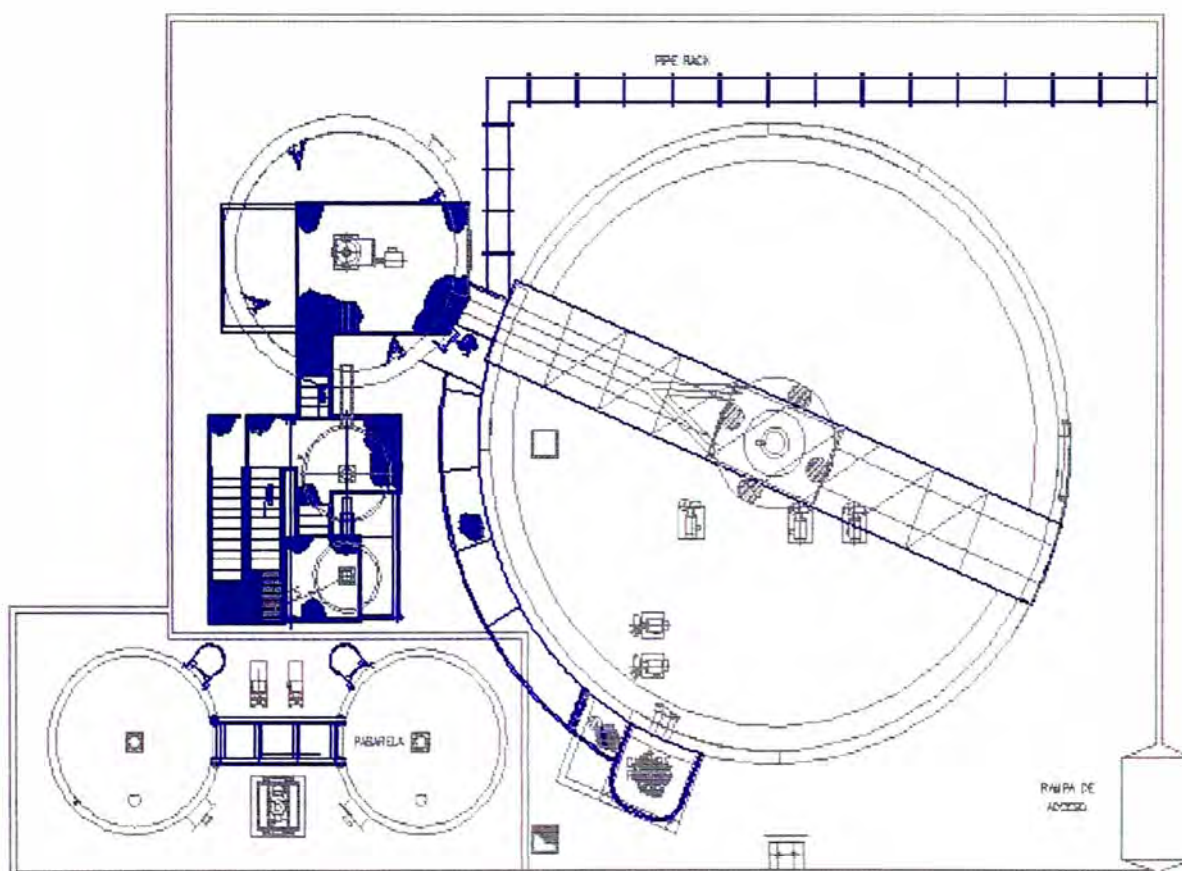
Vista de planta de escaleras, grating, barandas y pipe rack
